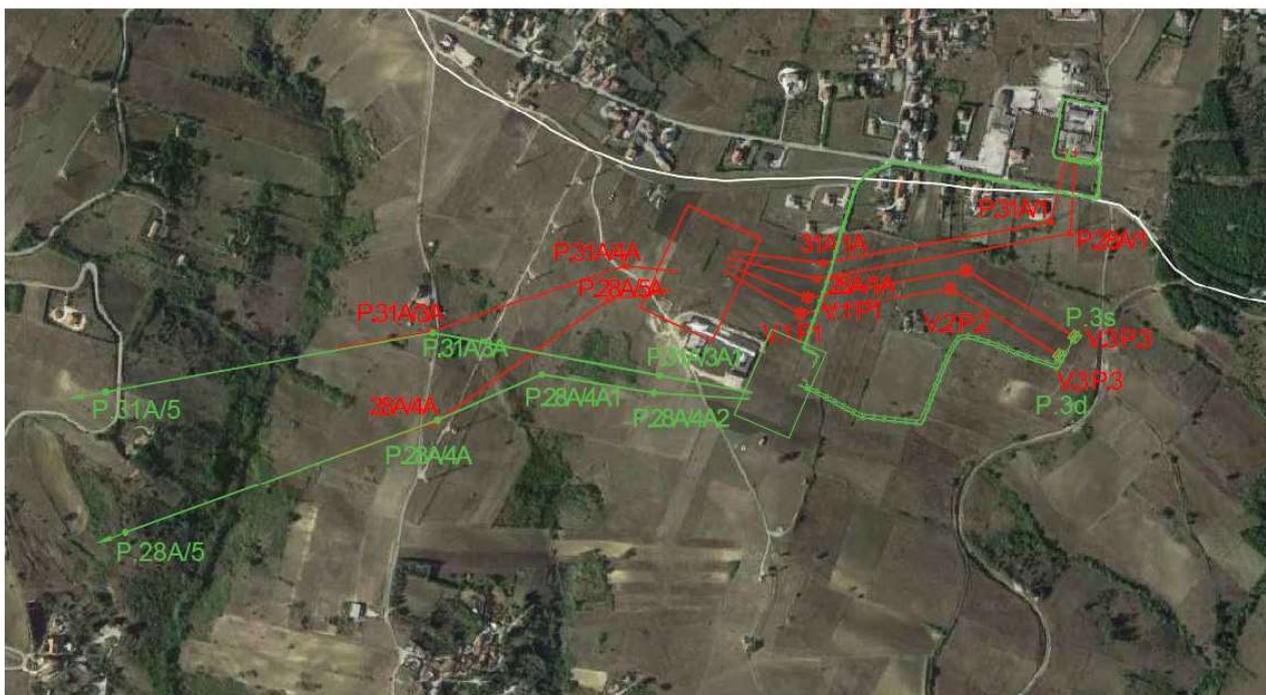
Tracciato autorizzato (rosso) e previsto in variante (verde)
